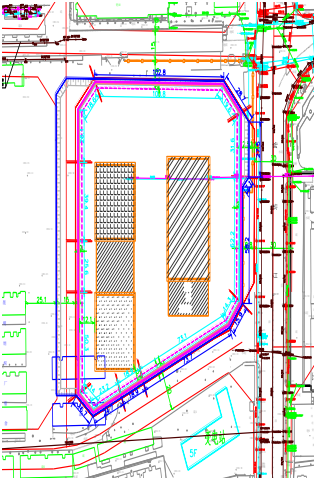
基坑支护平面图 (刘总: 这个图上缺支护剖面划分的编号, 麻烦补充一下)
